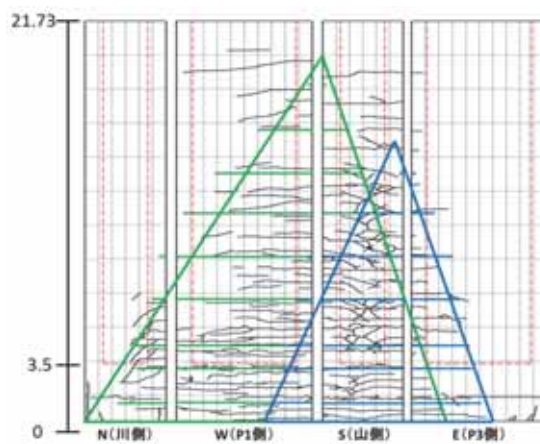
P2 橋脚ひび割れ再現図 (2 方向)
